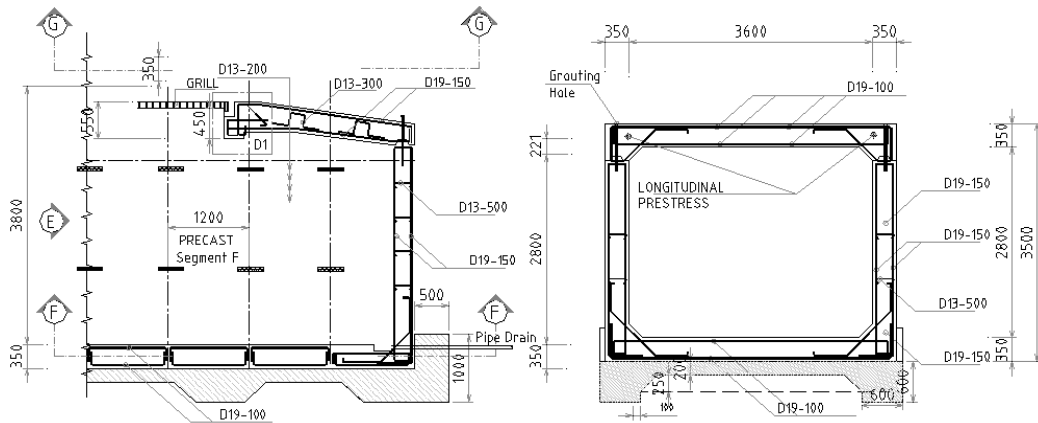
Pembagian segmen beton pracetak pada Tunnel Feeder
